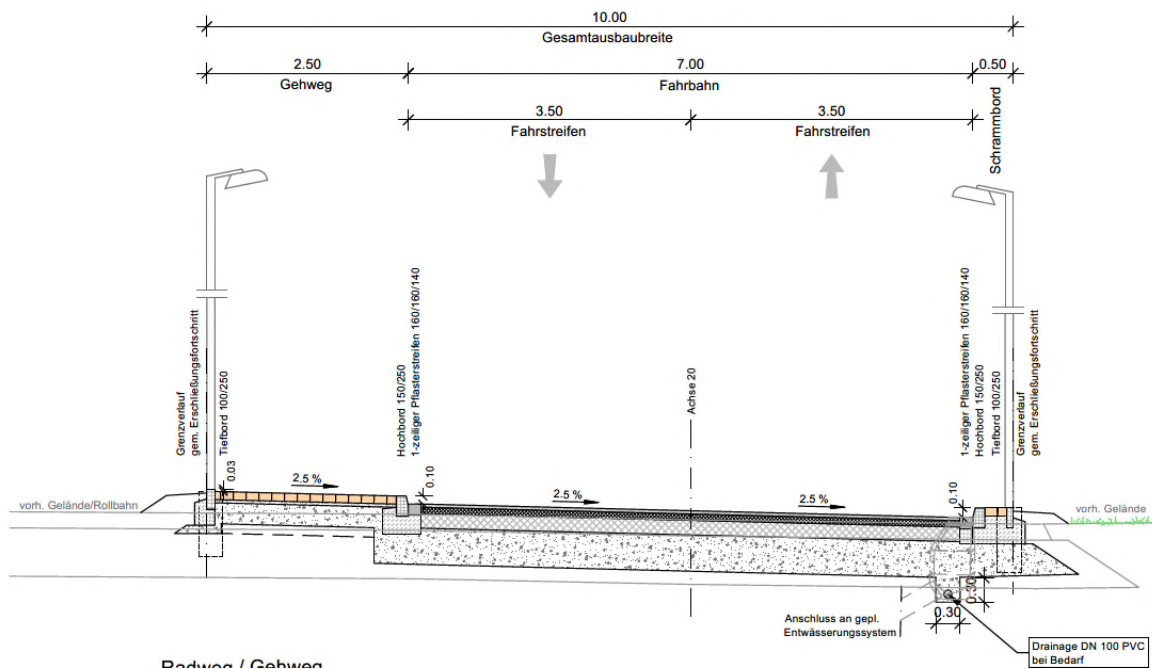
Straßenquerschnitt Planstraße M, Hauerschließung (Quelle: Vorabzug Ingenieurbüro Oppermann GmbH, Vellmar, 13.11.2025)
